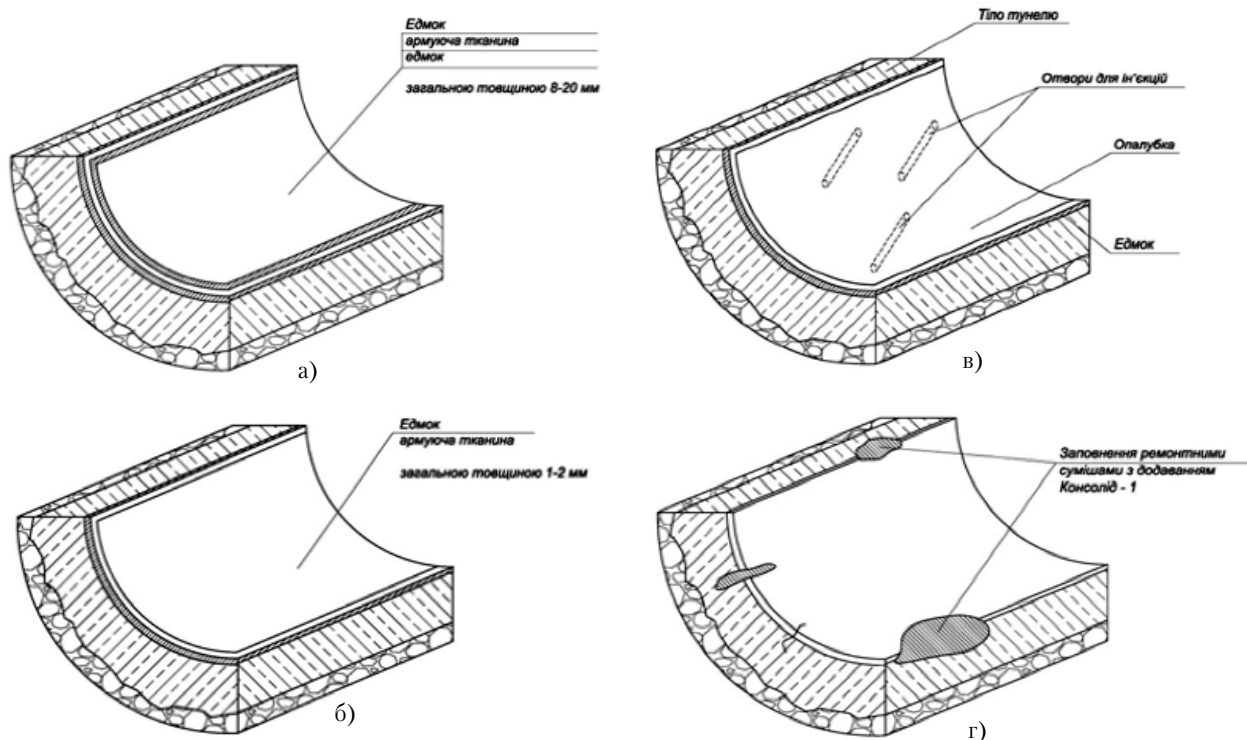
Схема виконання робіт із ремонту внутрішньої поверхні тунелю: а – з утворенням суцільного захисного покриття з армуванням спеціальними тканинами товщиною 8-20мм, б – з утворенням суцільного захисного покриття з армуванням спеціальними тканинами товщиною 1-2мм, в – з утворенням суцільного захисного покриття ін'єктуванням композитного матеріалу в простір утворений опалубкою та стінкою тунелю, г – додавання полімерної композиції до ремонтних сумішей
